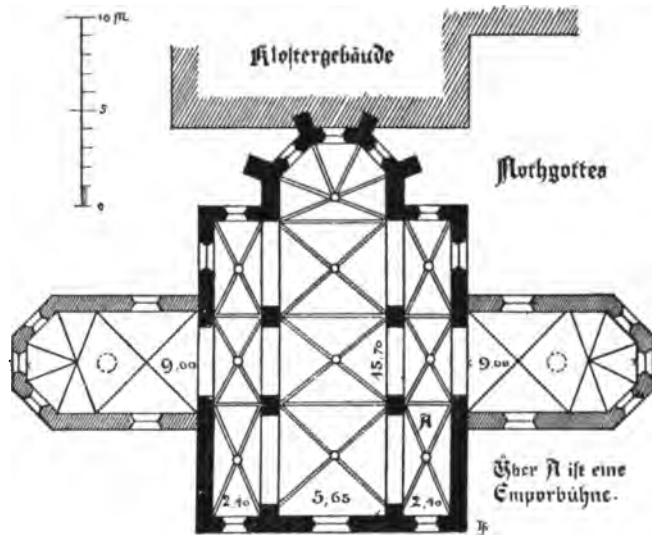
Nothgottes. Grundriss der Klosterkirche.
